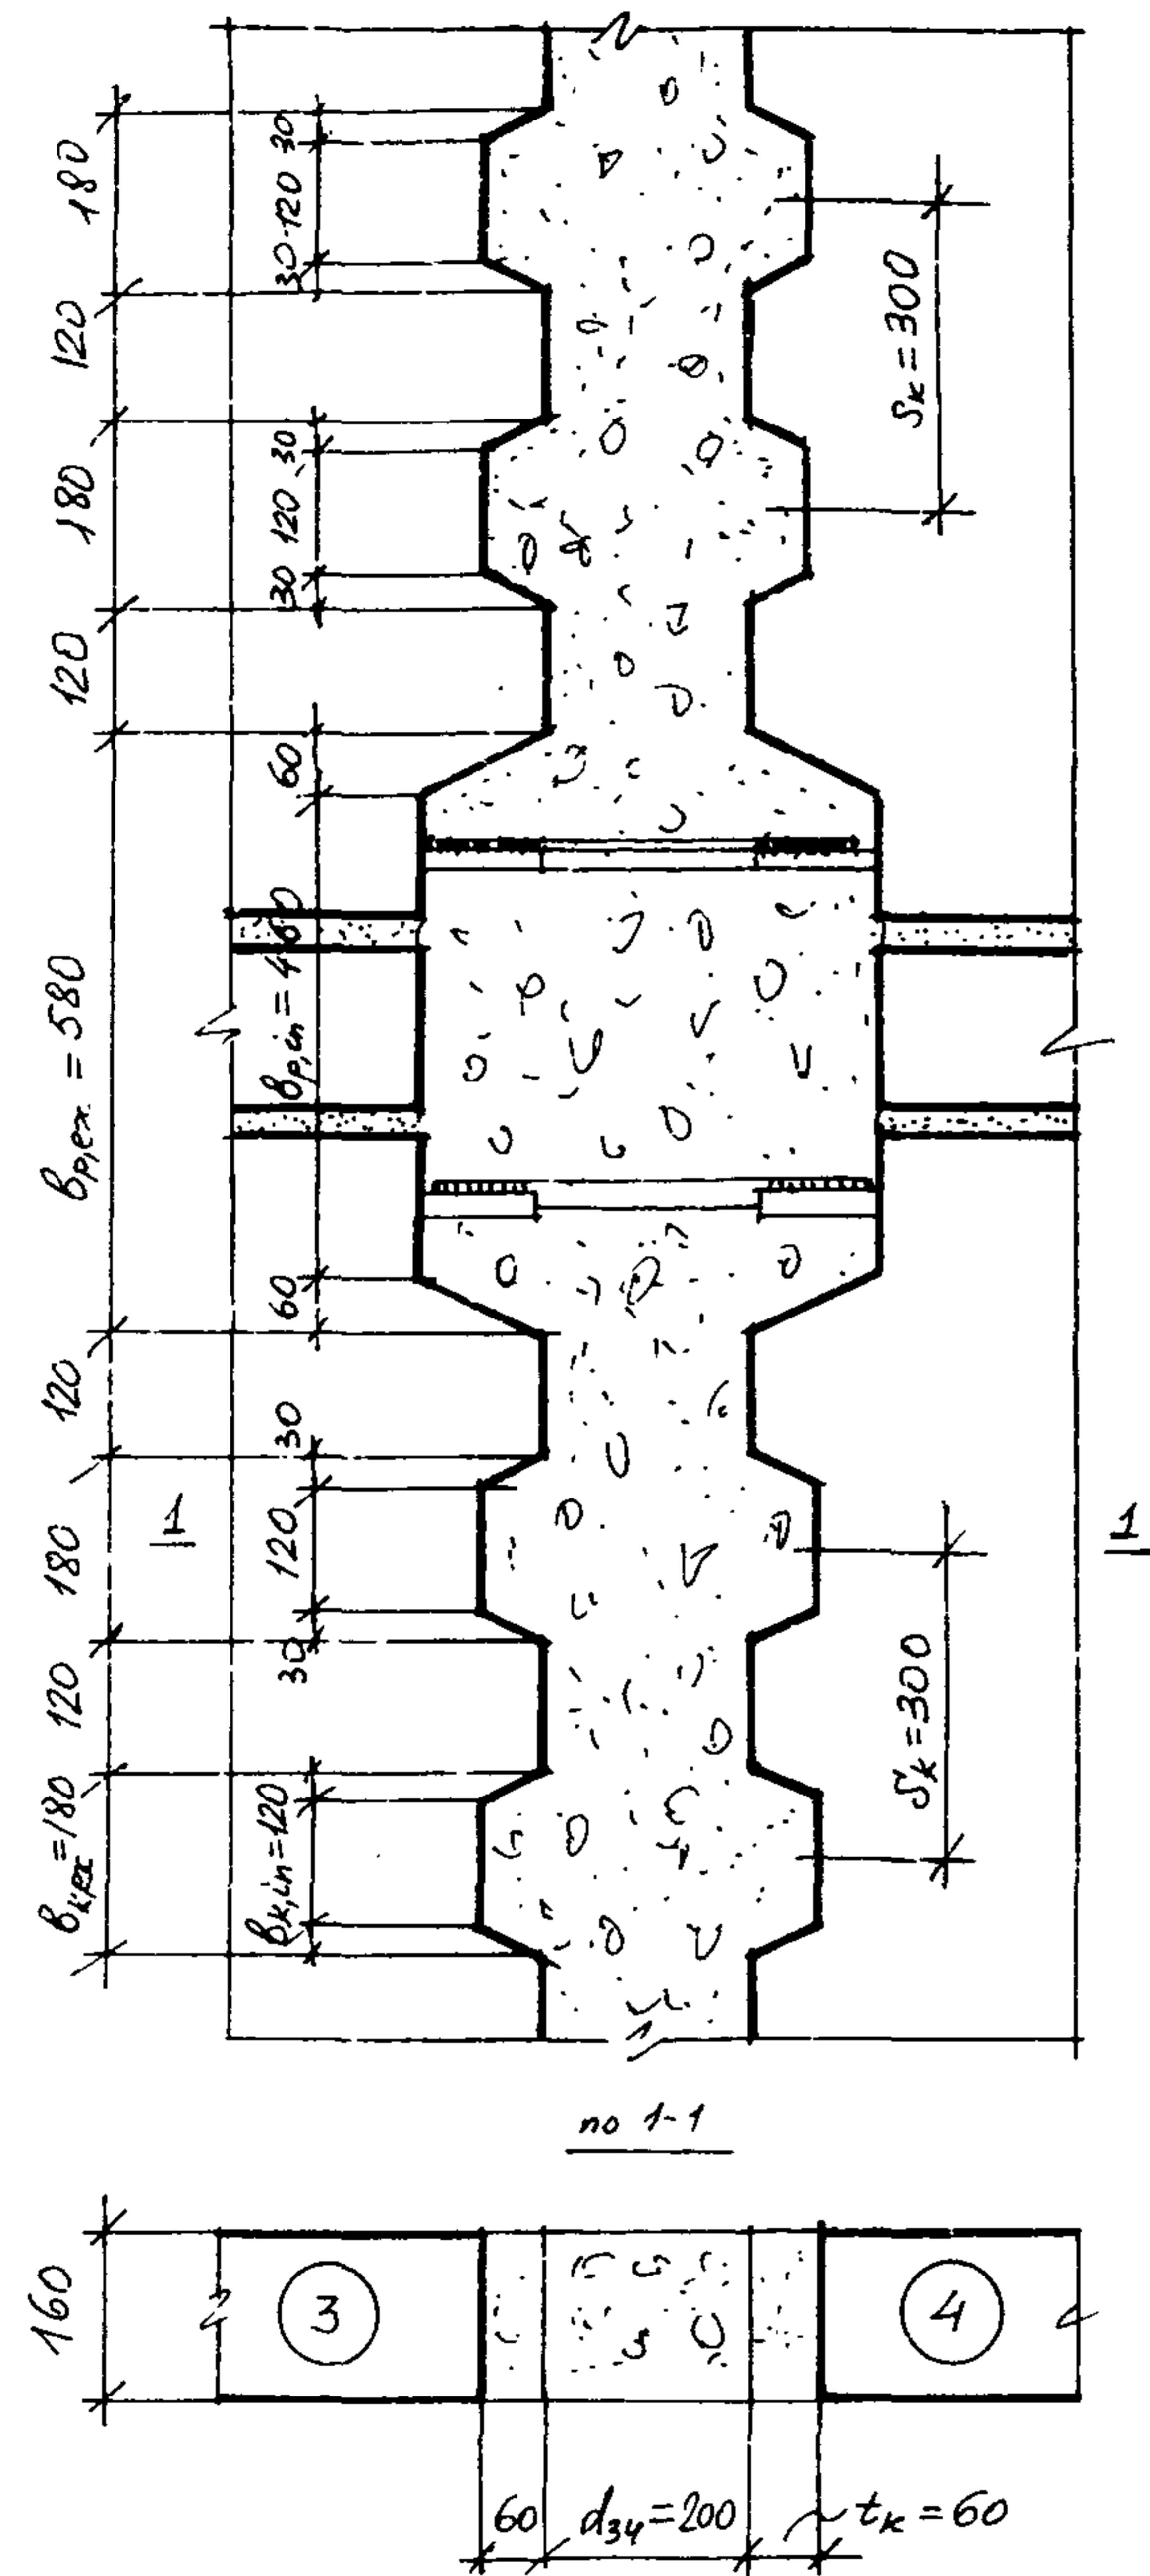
Вертикальный железобетонный шпоночный стык двух стеновых панелей (к примеру 9)
